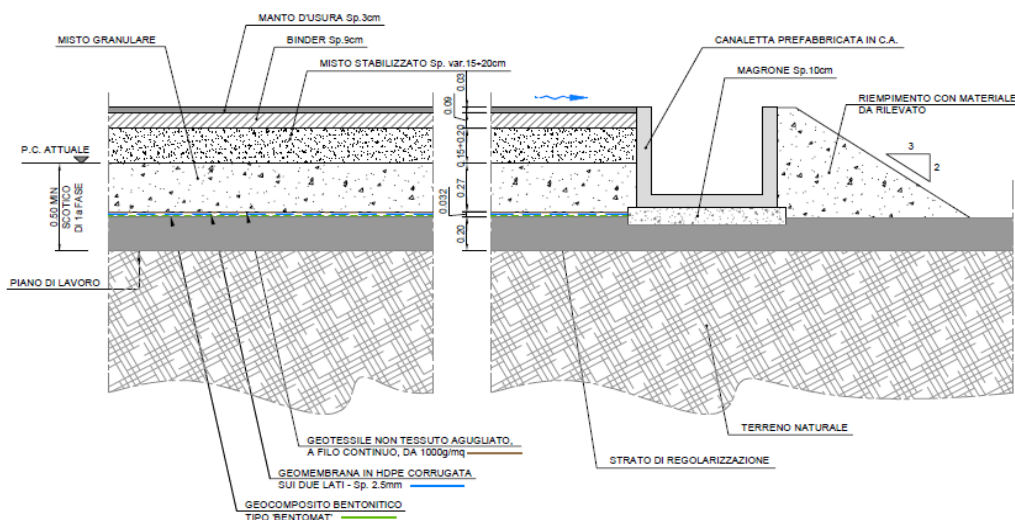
Sezione tipico pacchetto impermeabilizzazione e copertura piazzale via Morosini
